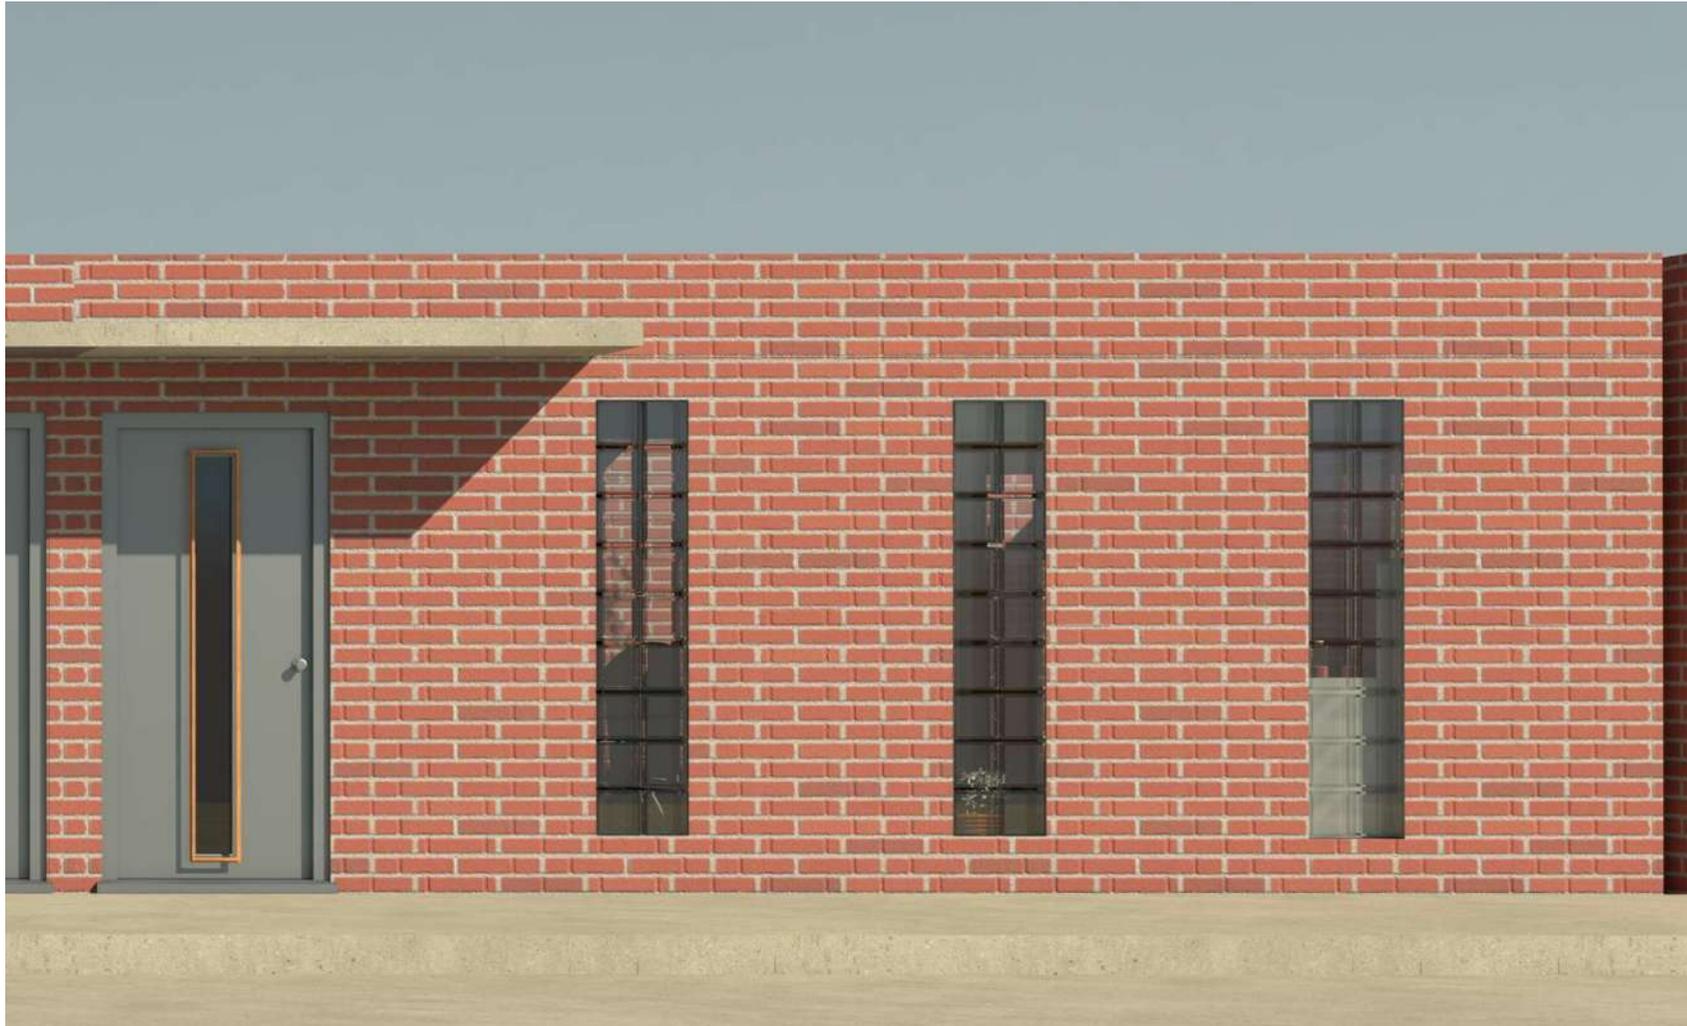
Render exterior, fachada, elaboración propia BMAF
